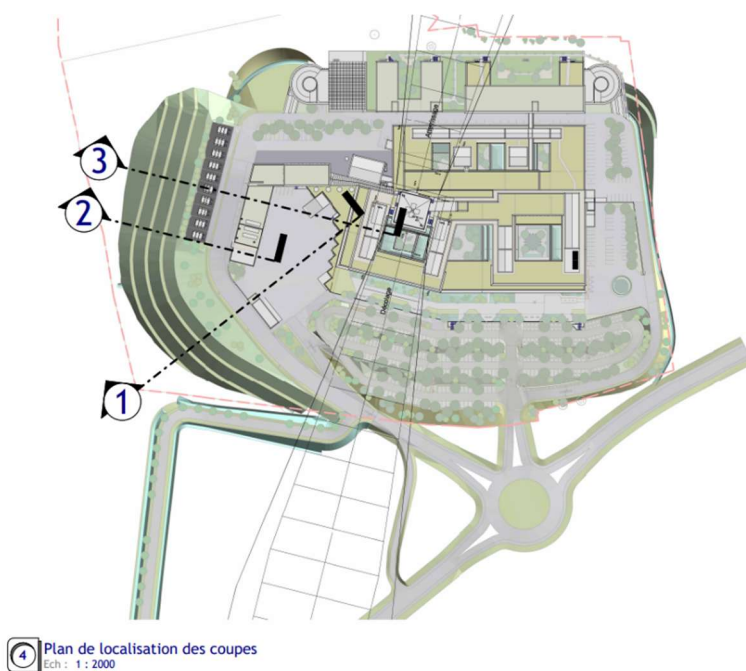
Plan de masse du projet avec les coupes 1 à 3 centrées sur le talus Ouest.
